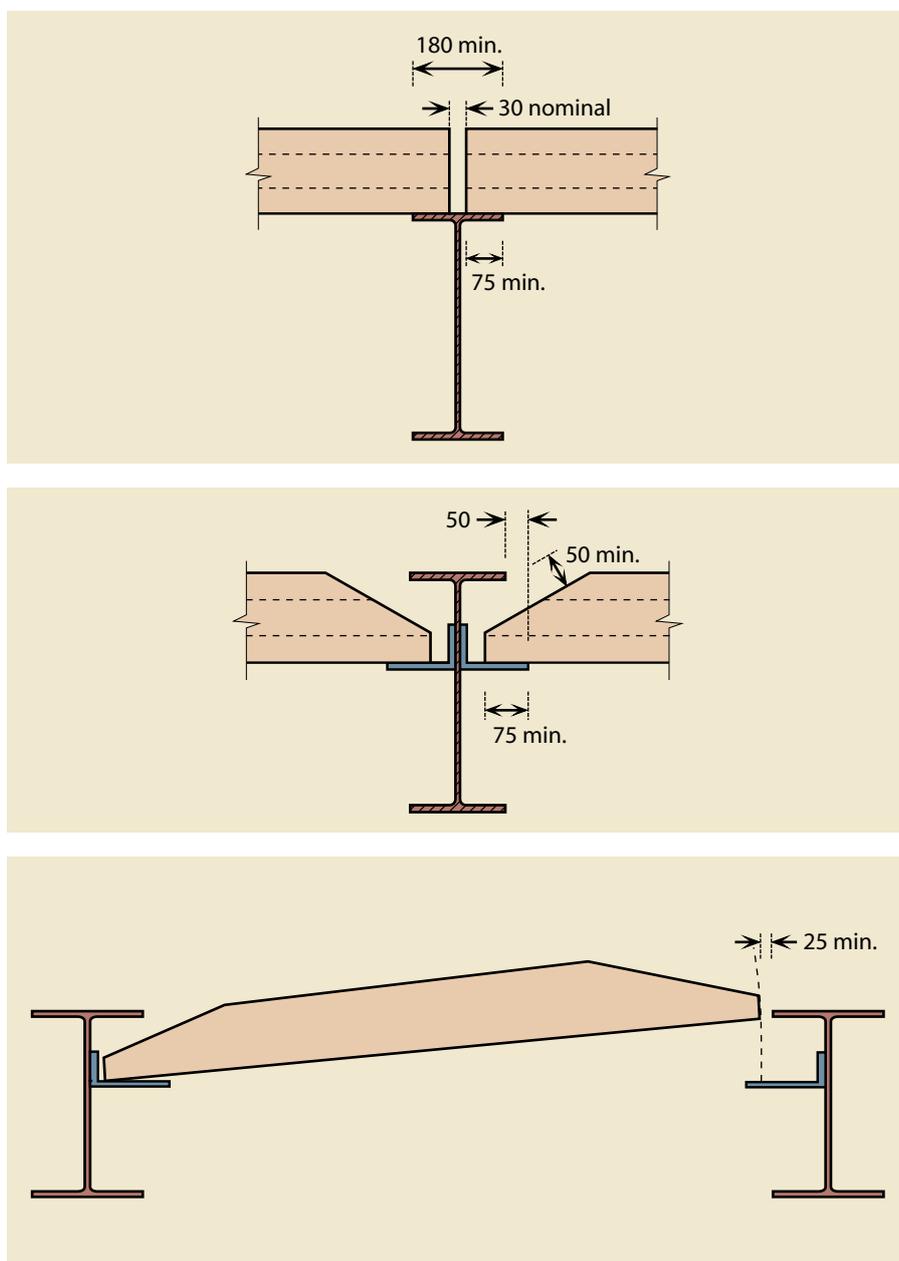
Distancias requeridas para las placas prefabricadas en el forjado
